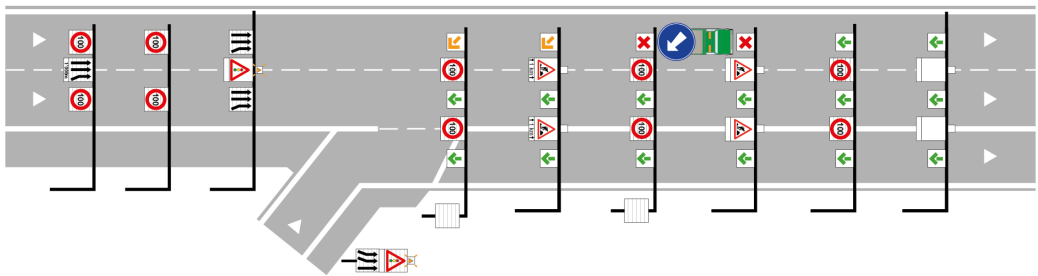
33.7+76.1 BAU ouverte : exploitation de la voie de dépassement lors de travaux d'entretien.
